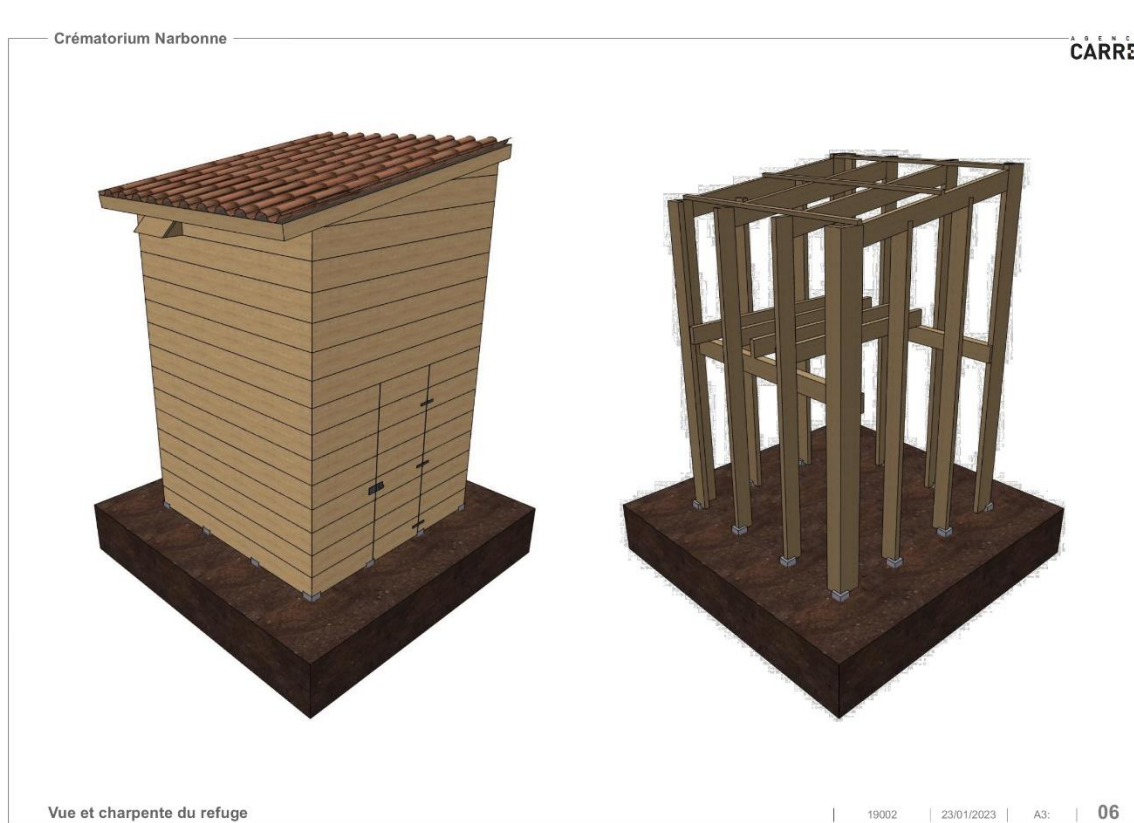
plans de l'aménagement en faveur de la faune (source : Carré Architectes)
